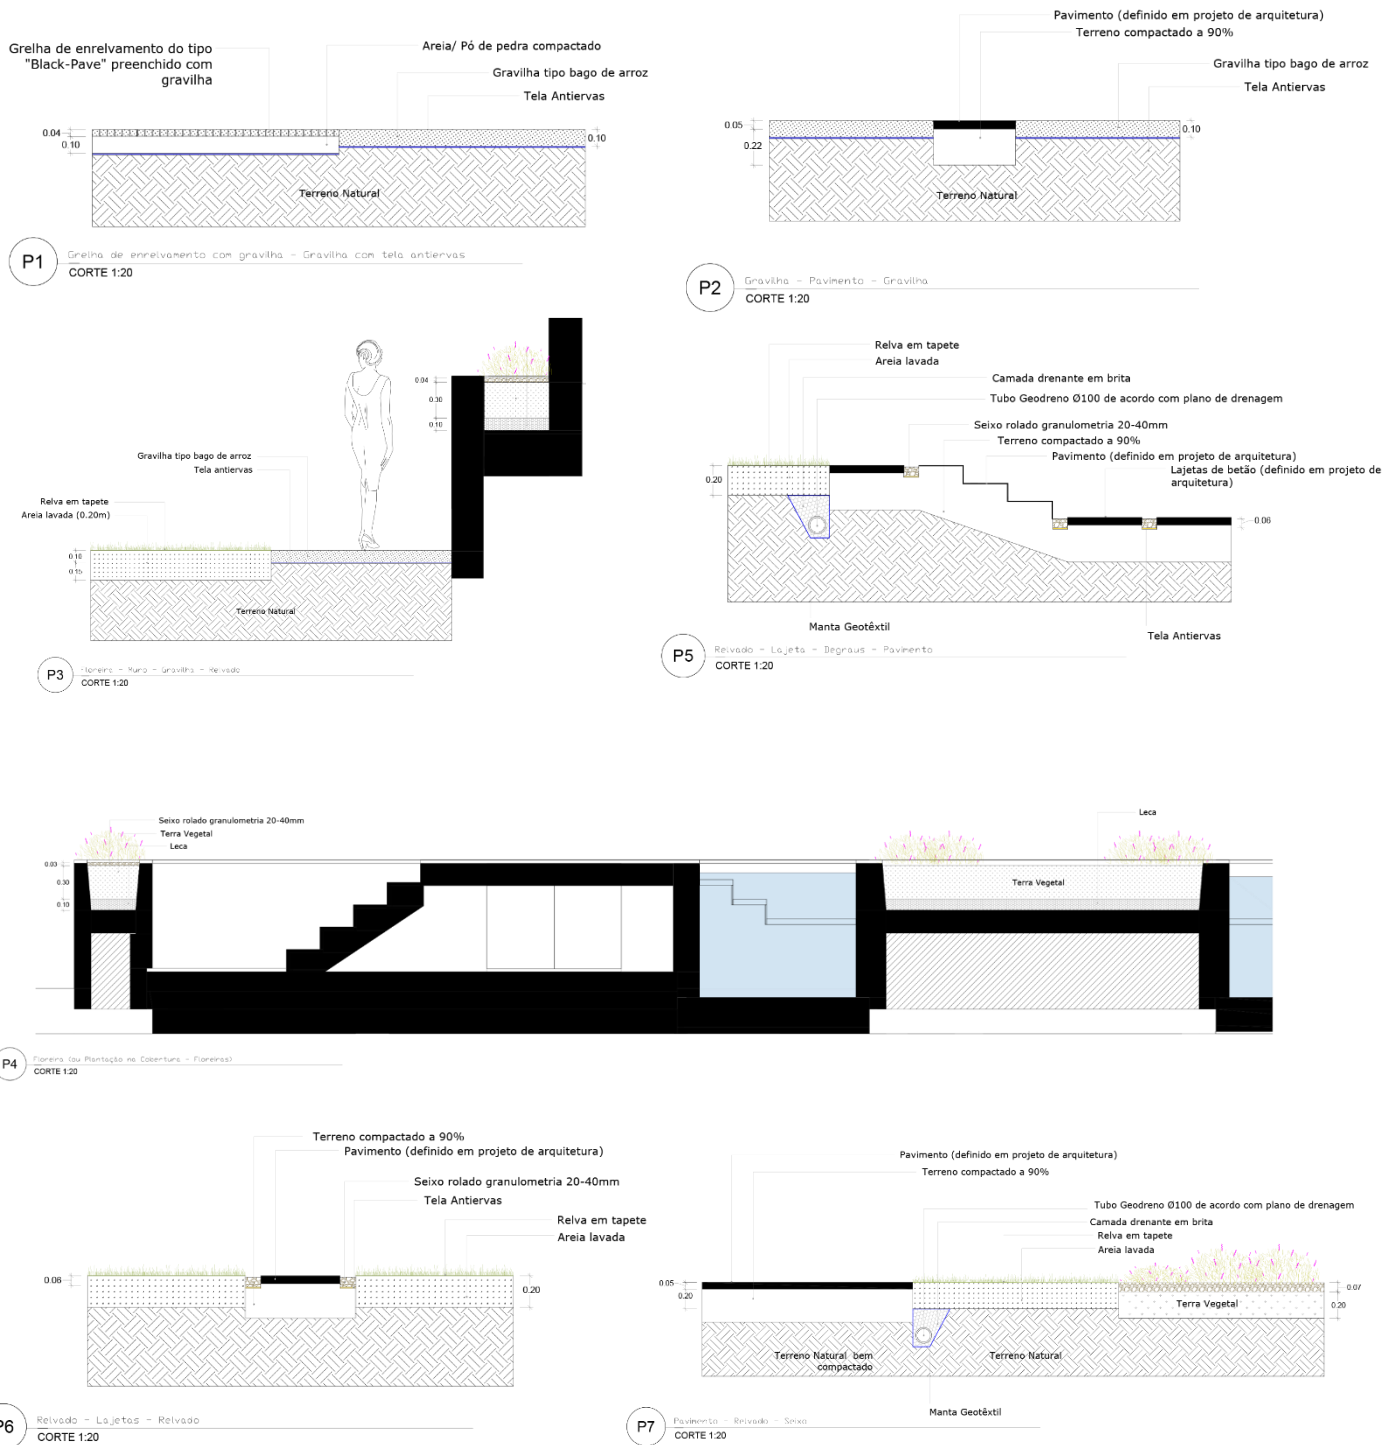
19. Representação do Plano de Pormenores de Construção do Condomínio Lugar das Lapas, Alvor. Fonte: Autora, 2022.
